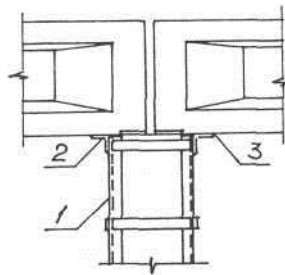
(1 — вертикальные уголки, 2 — опорные уголки, 3 — подстилающий слой раствора)
